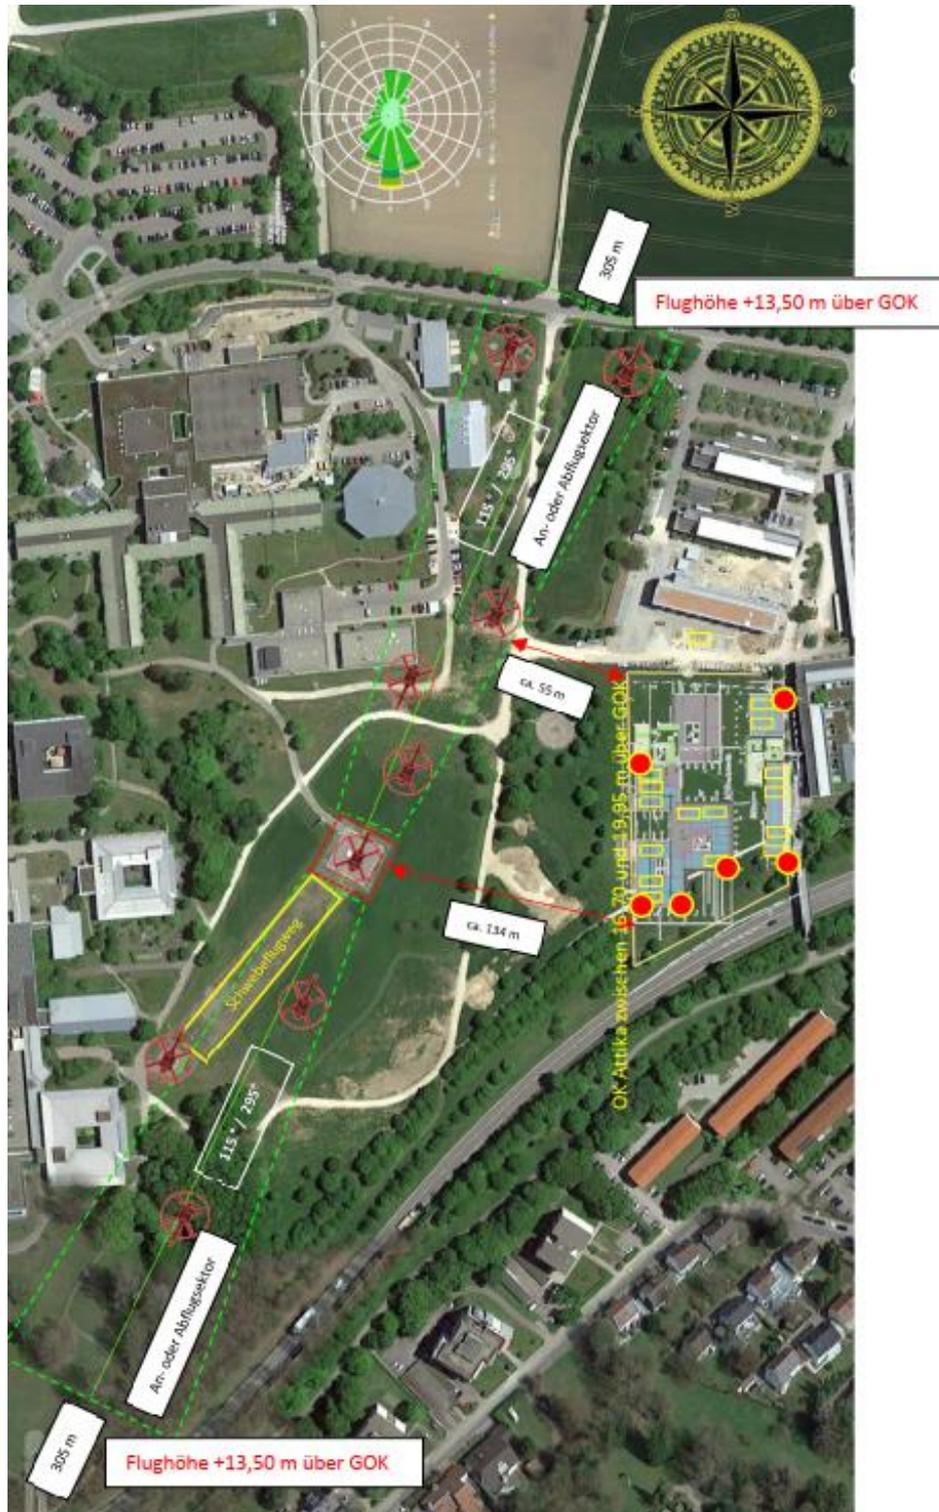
Übersichtslageplan, Freier Sachverständiger Herr Becker, o. M.
